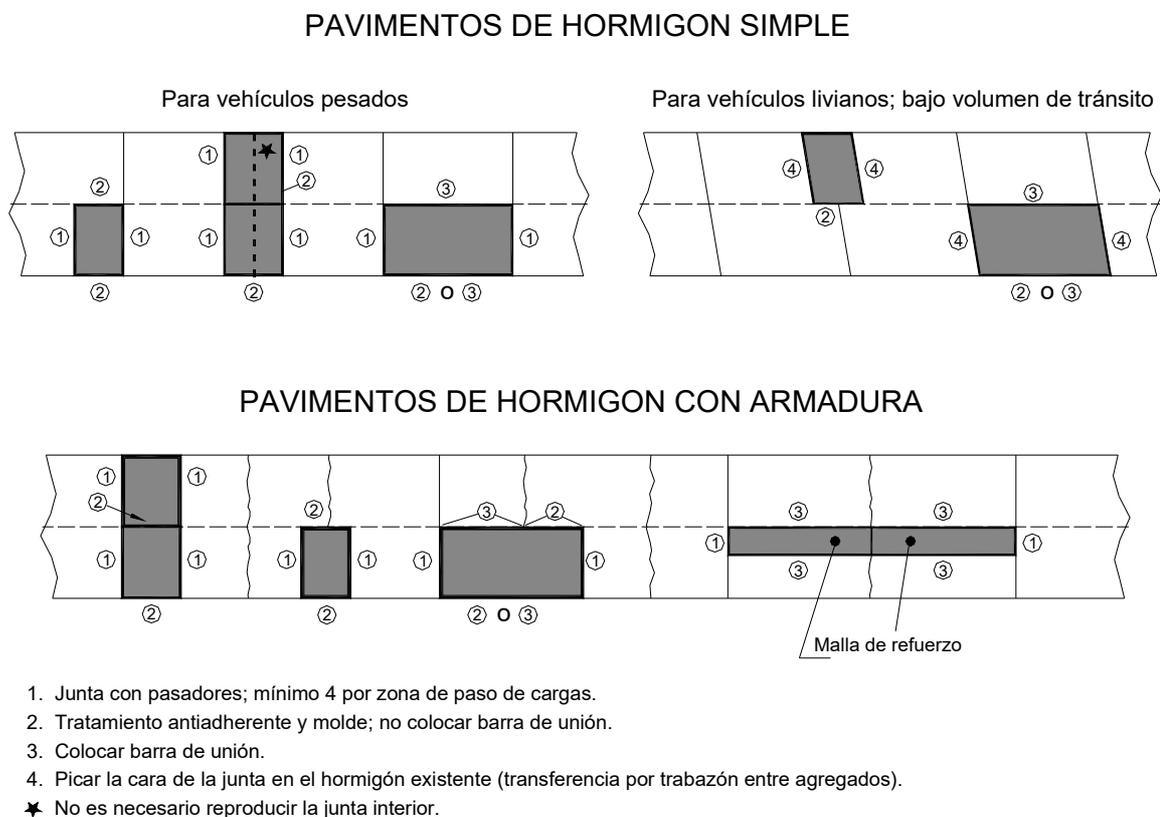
Diferentes tipos de juntas transversales y longitudinales en reparaciones de pavimentos.
